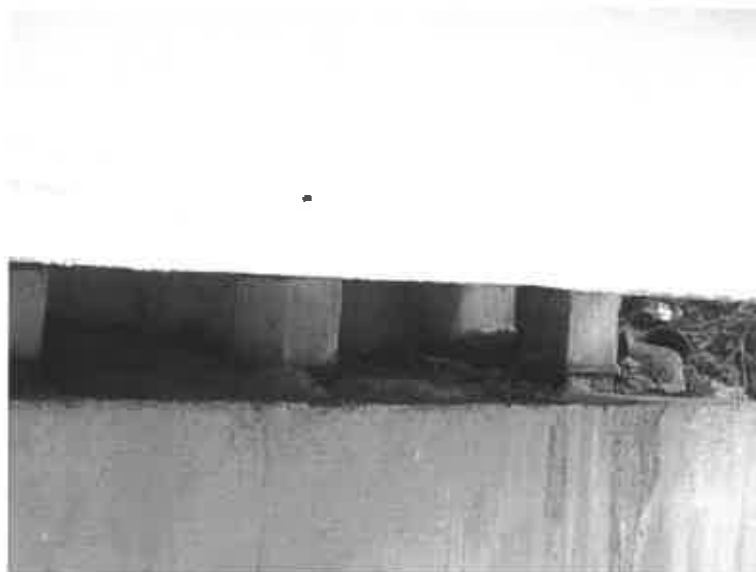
Bancheta cuzineților la culeea mal stâng
